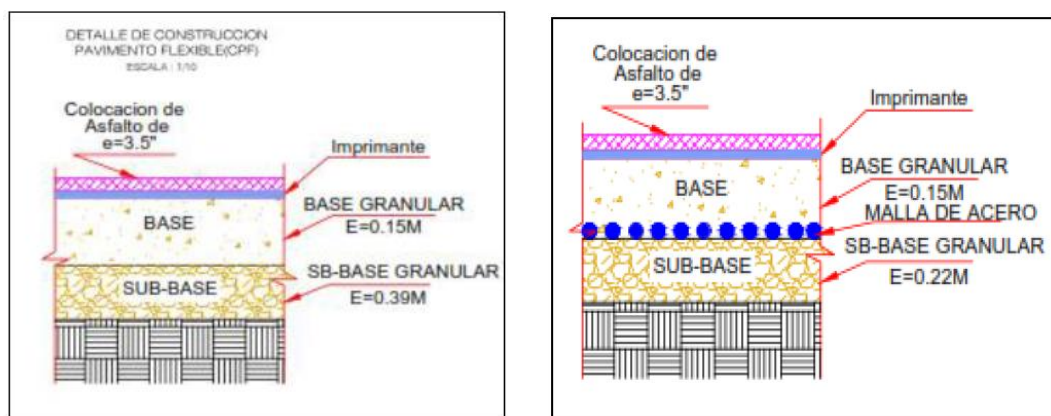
Diseño de un pavimento flexible con y sin refuerzo
